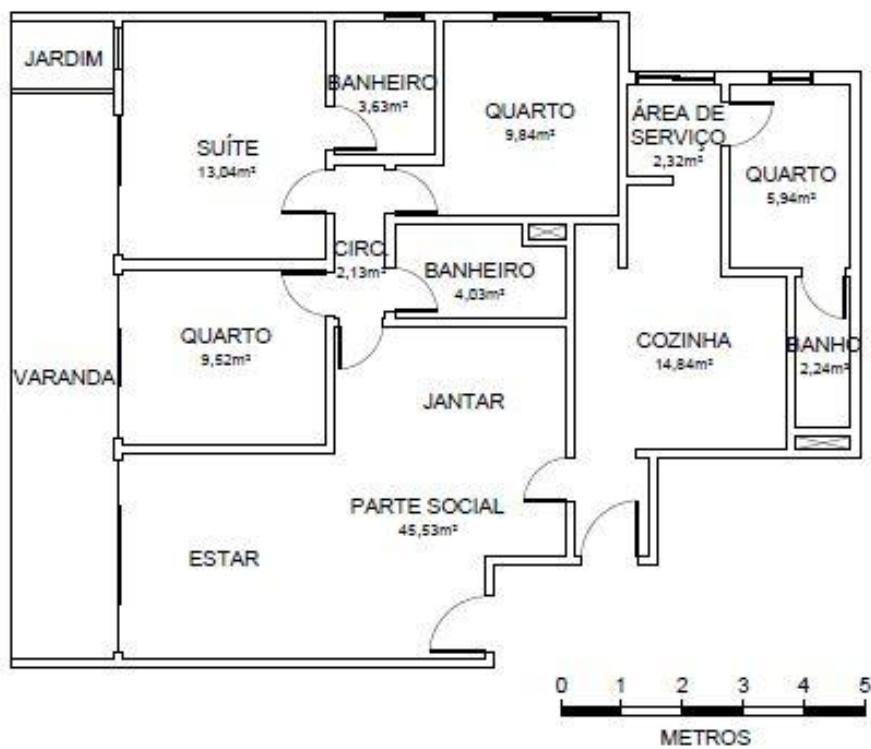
Condomínio Fleurville – Planta baixa do apartamento 202 – Bloco 2.
